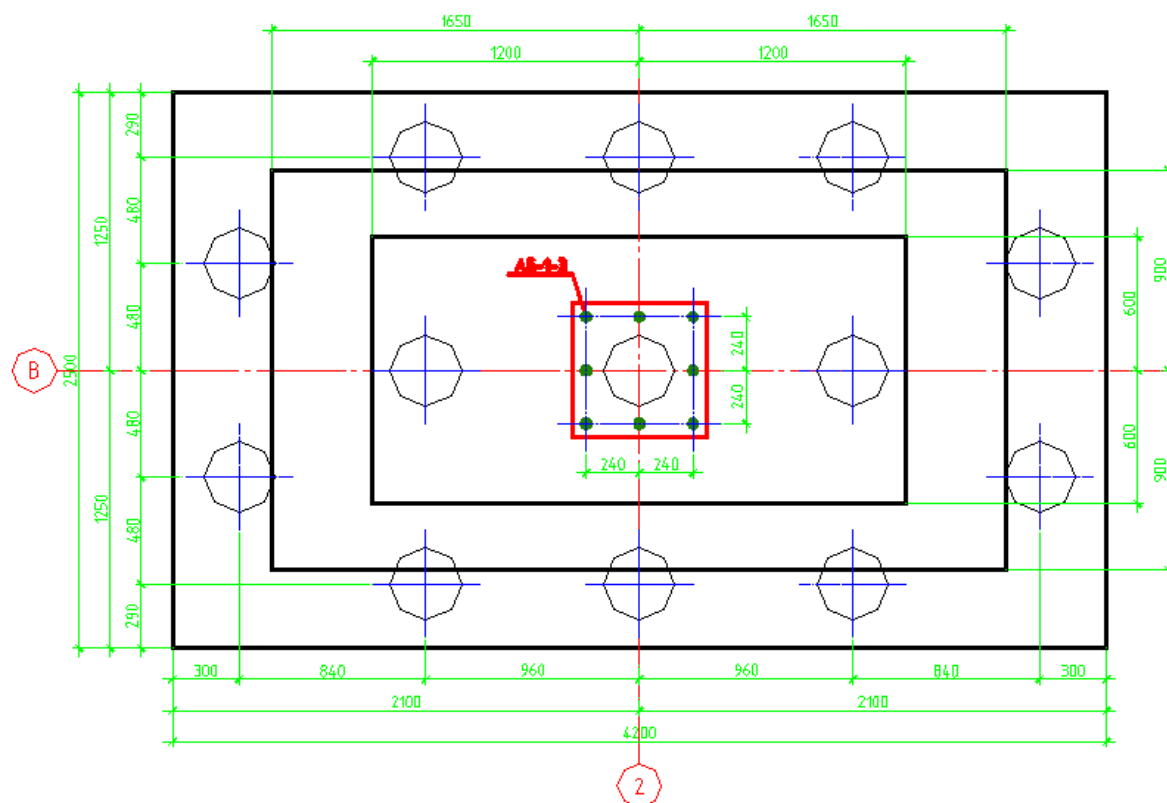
Схема расположения свай в наиболее нагруженном фундаменте
